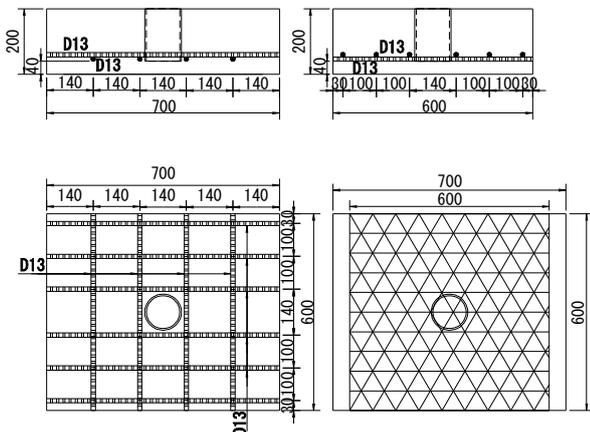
押し抜き試験の改良供試体形状図 (単位:mm)
